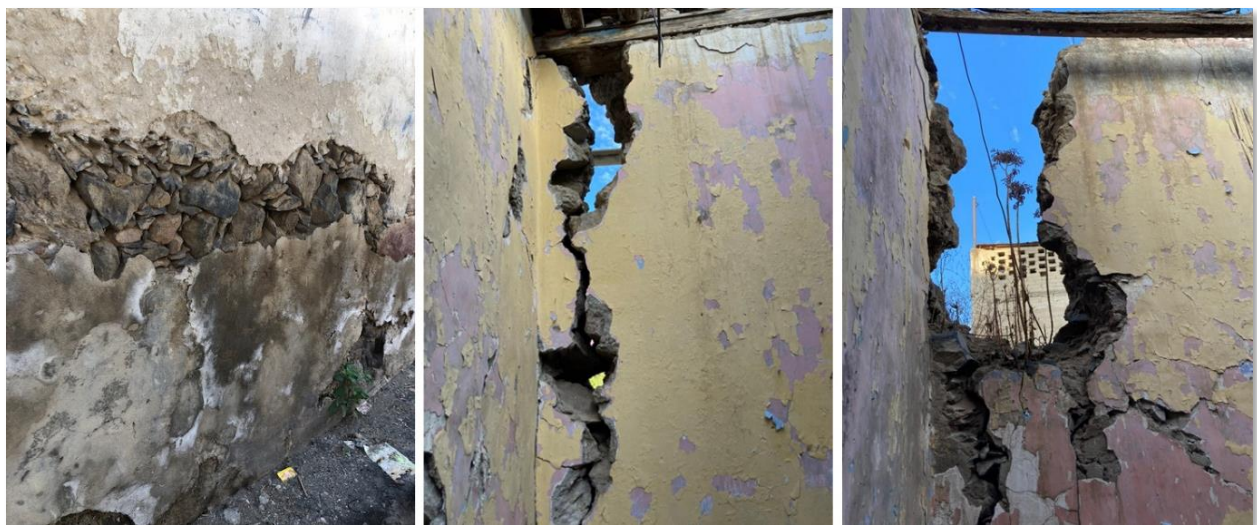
De izquierda a derecha: detalle muro exterior, grieta muro suroriente y grieta muro nororiente. Elaboración propia
